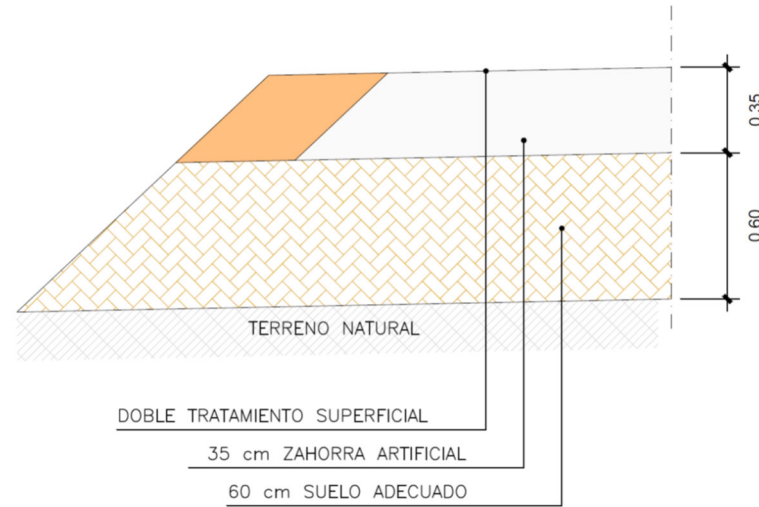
Detalle de sección 4211\* en caminos. DTS.
